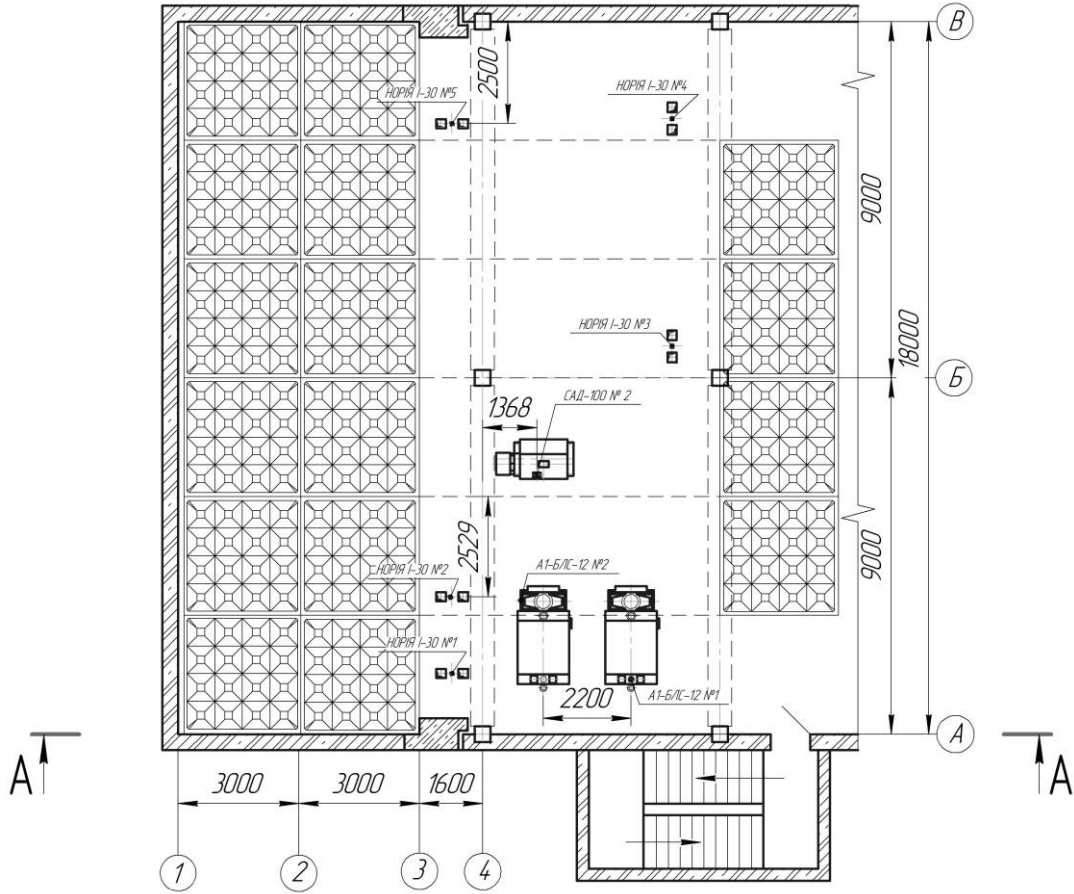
План третього поверху цеху з обробки насіння сої
